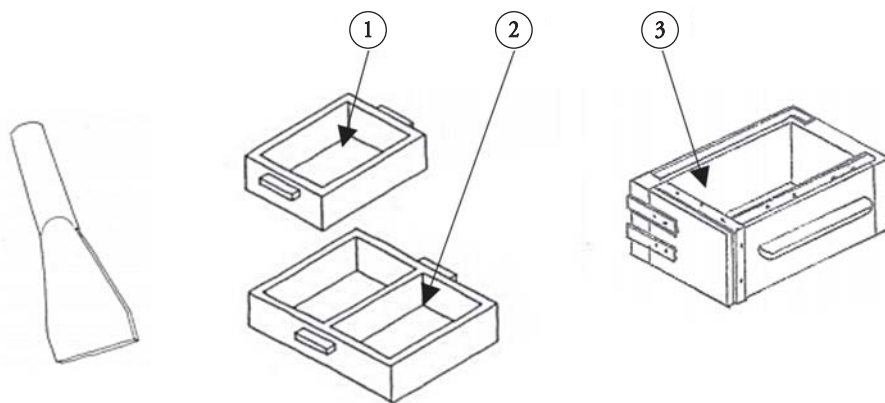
Utensílios para moldagem e compactação manual (socador) e moldes para adobes.
